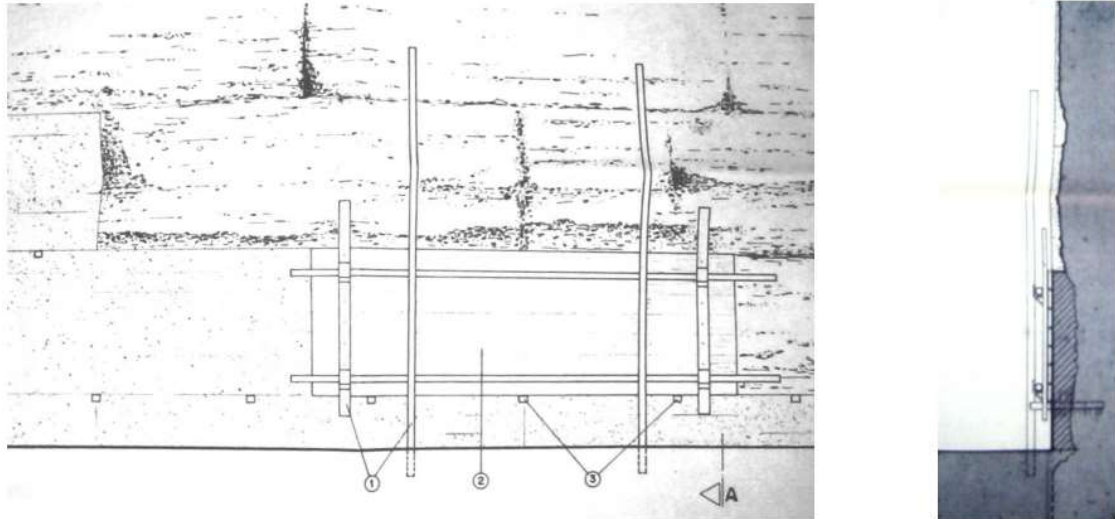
Detalles de los encofrados. Fuente: Proyecto de restauración de José García-Tapia.
